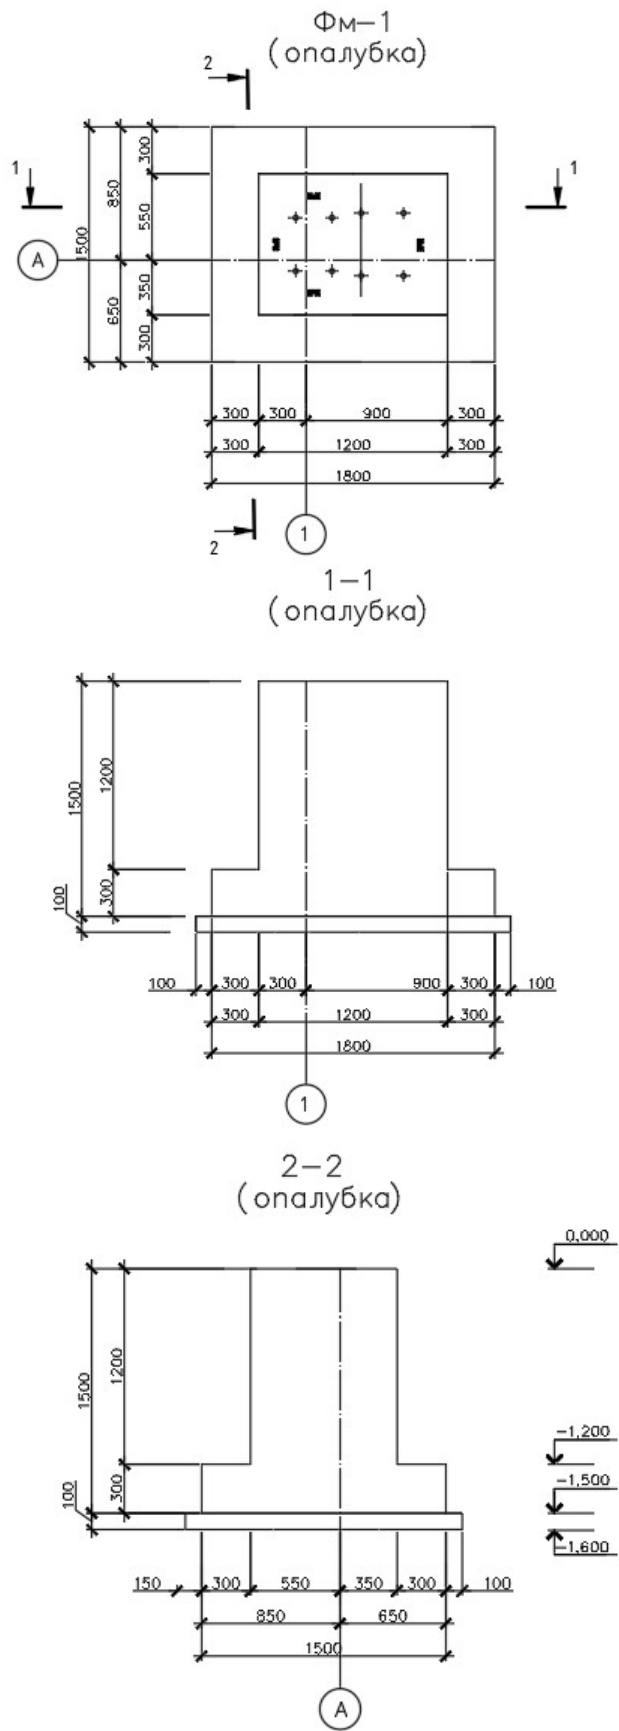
Столбчатый фундамент ФМ-1 под колонну К1
